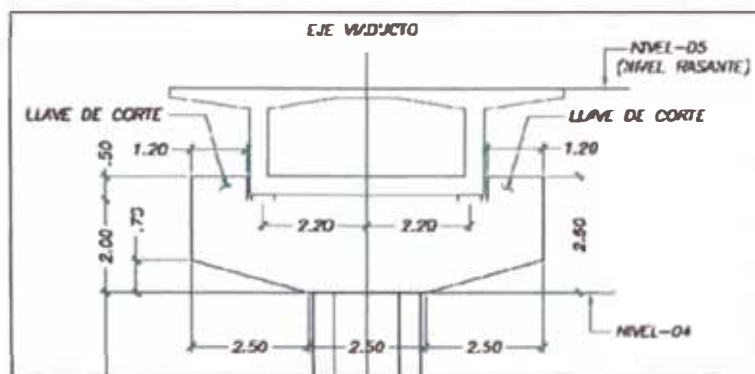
Sección Transversal Viga cabezal S48 y S52
